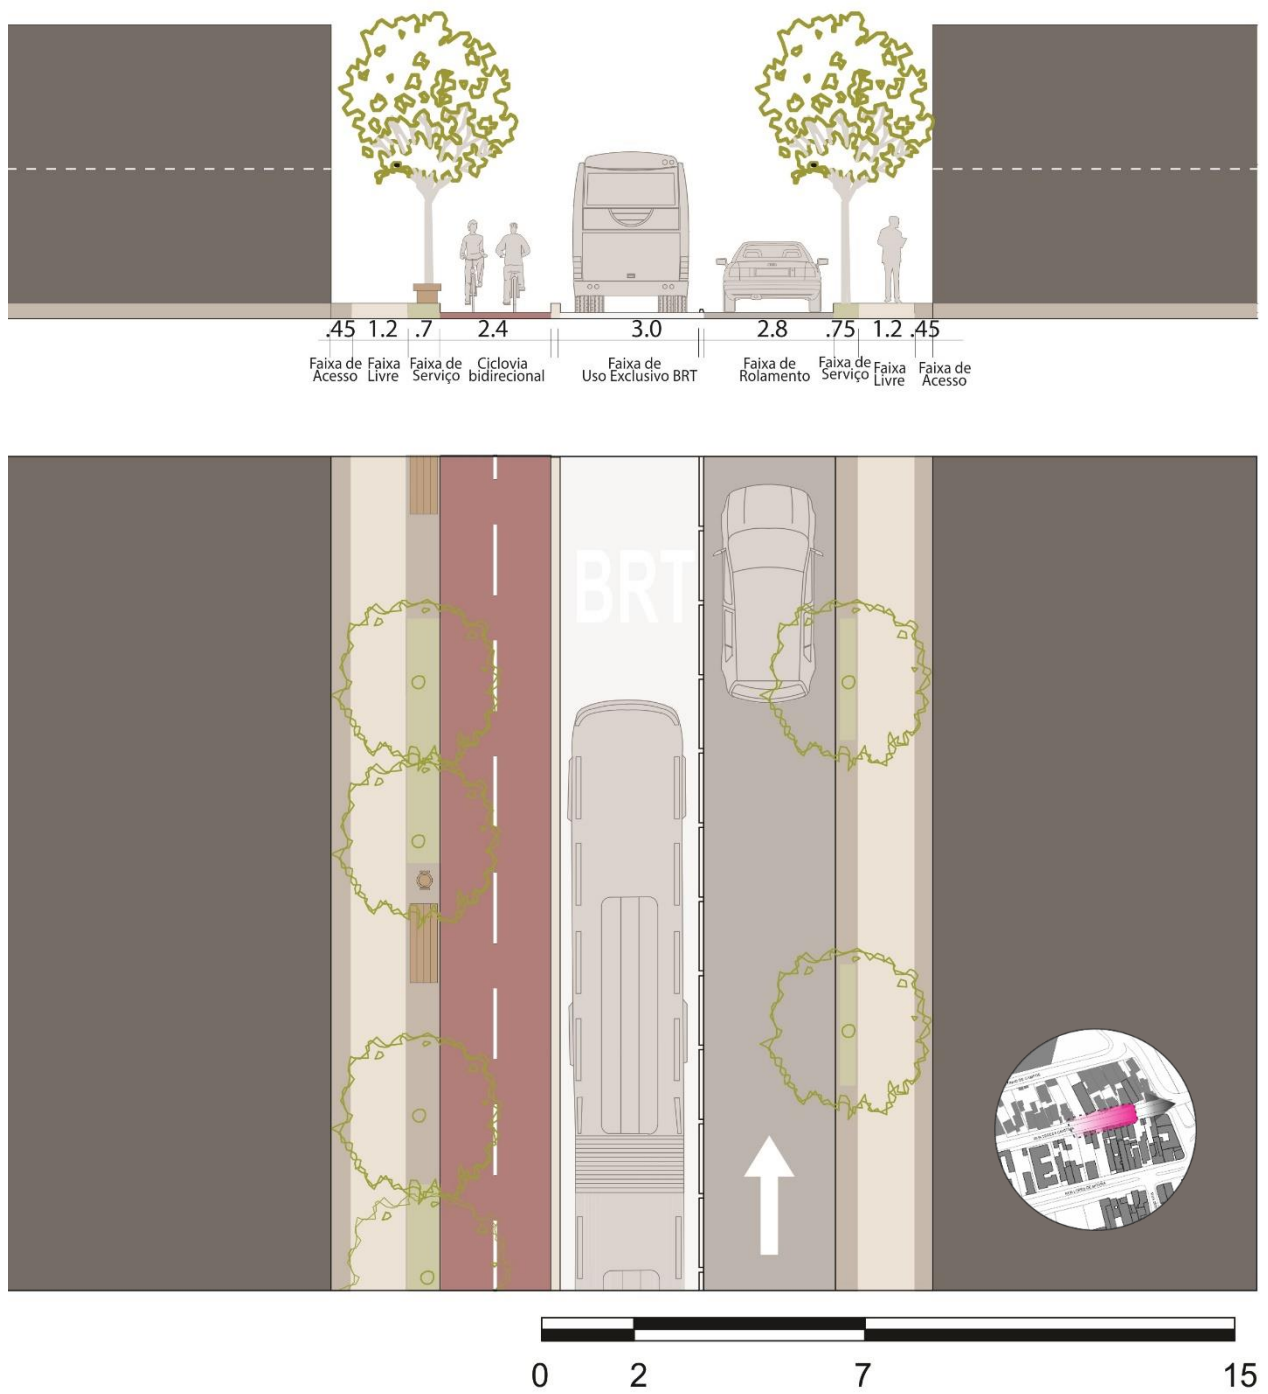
Detalhamento Perfil Rua Teresa Cristina
